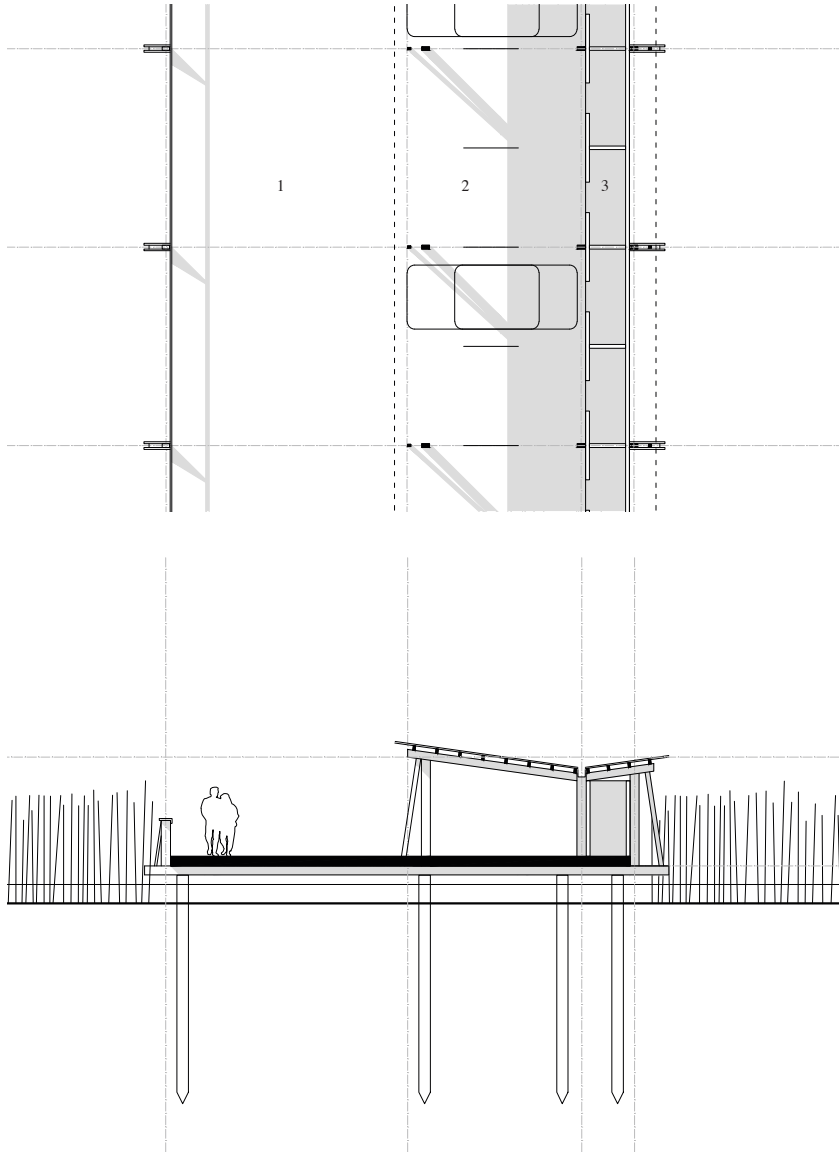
Infrastrukturobjekt Parken, o: Grundriss, u: Querschnitt
